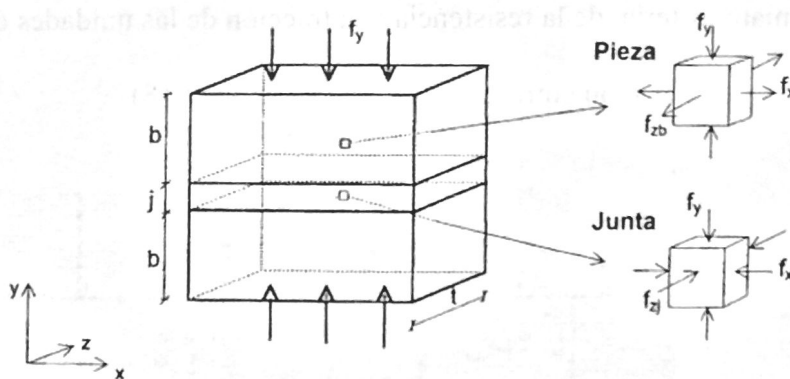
Estado de esfuerzos en la pieza de mampostería y en las juntas de mortero
